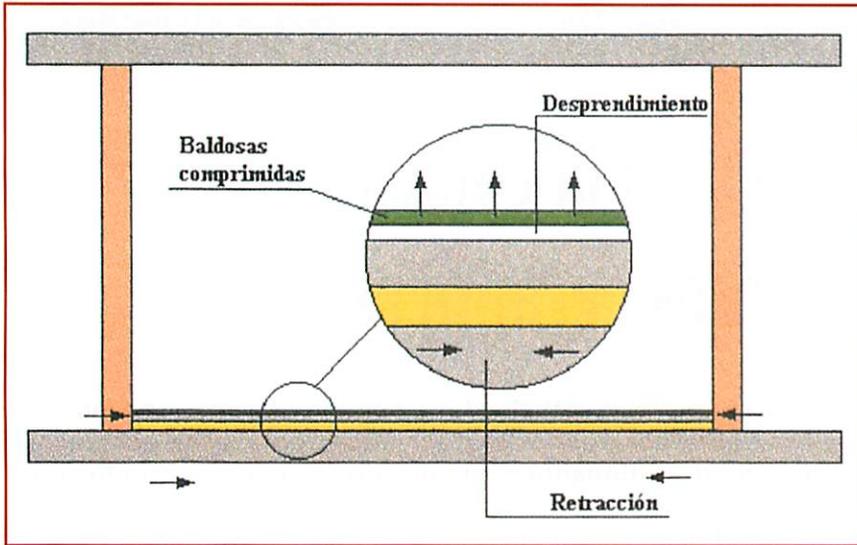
Ejemplo de esfuerzos introducidos en un pavimento desde la estructura.
